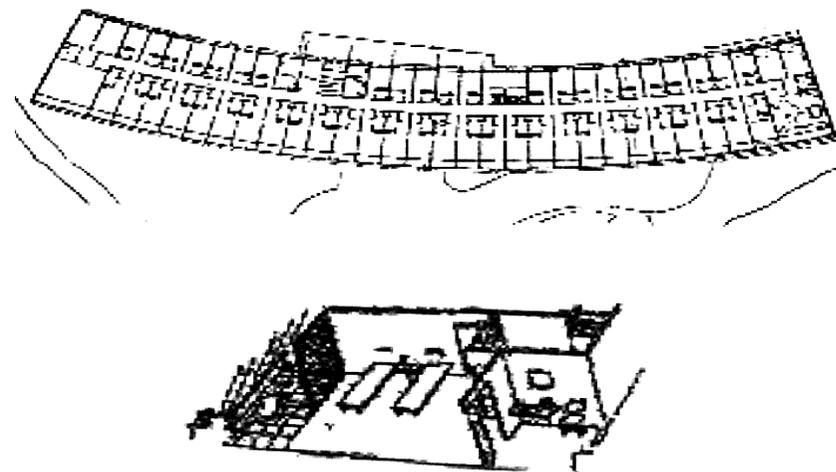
Planta do pavimento tipo, na foto acima e perspectiva axionométrica do apartamento na foto abaixo. Hotel da Pampulha Fonte Stamo Papadaki, 1951, p104/7.
